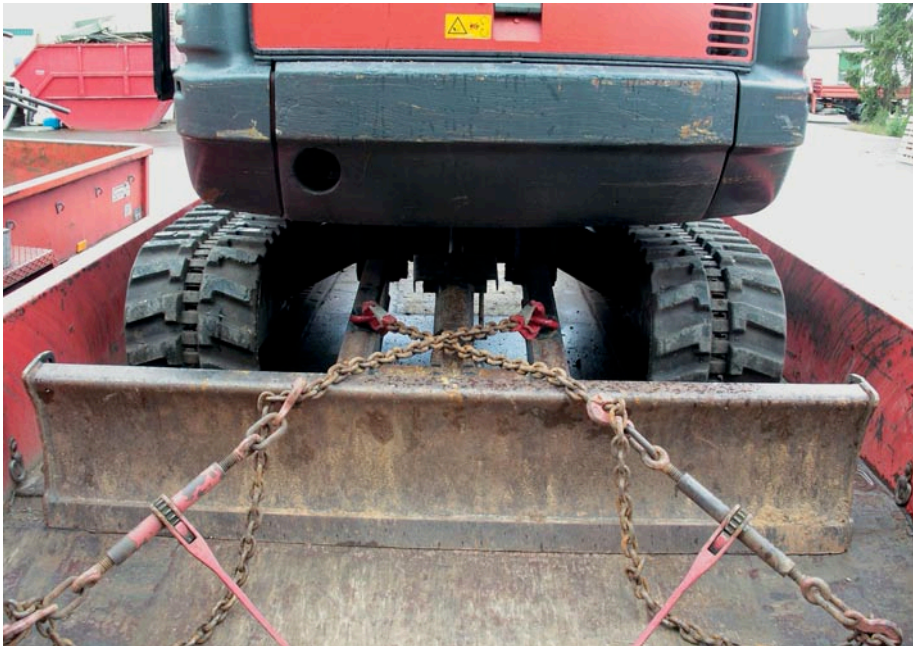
Zurrpunkte am Bagger durch das Bau-Unternehmen in Abstimmung mit dem Hersteller nachgerüstet, damit eine ordnungsgemäße Ladungssicherung durchgeführt werden kann
